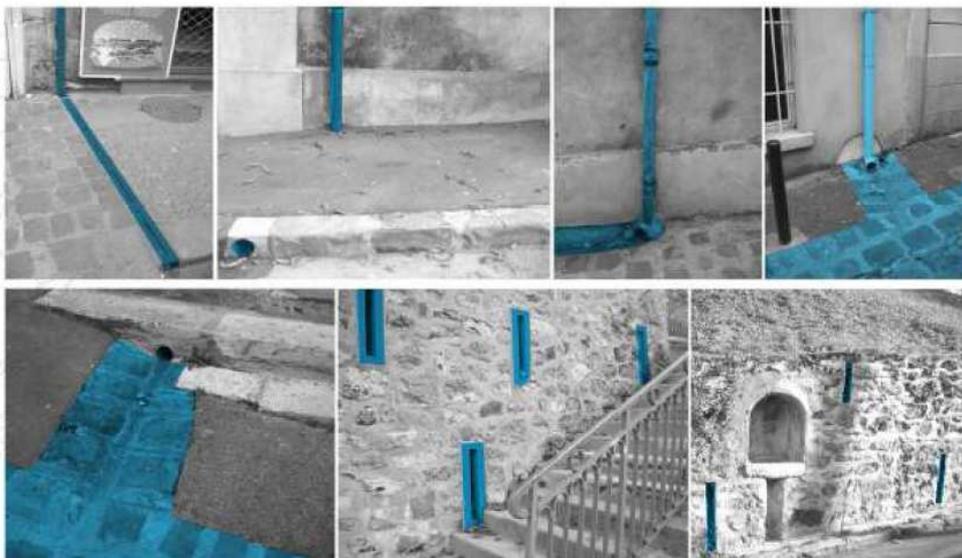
Exemples de drainage des eaux pluviales et de sources (1/2)
